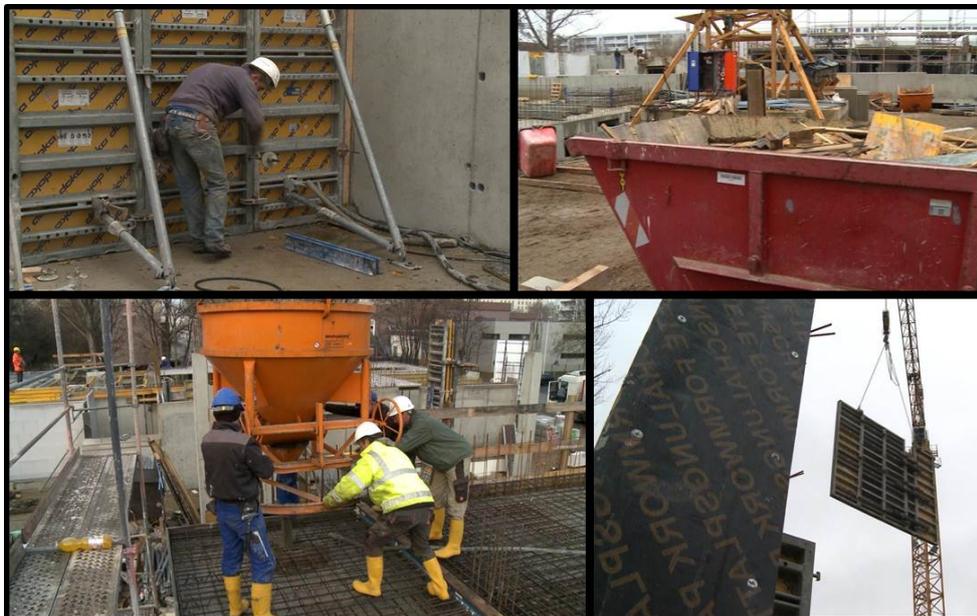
Konventionelle Ortbetonbauweise mit Schalungssystemen
